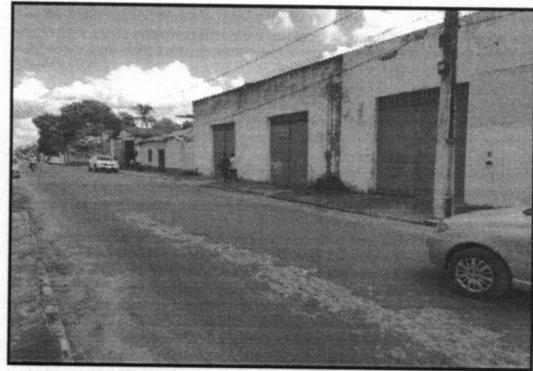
Vista do logradouro de acesso ao imóvel, com destaque ao pavimento asfáltico.
